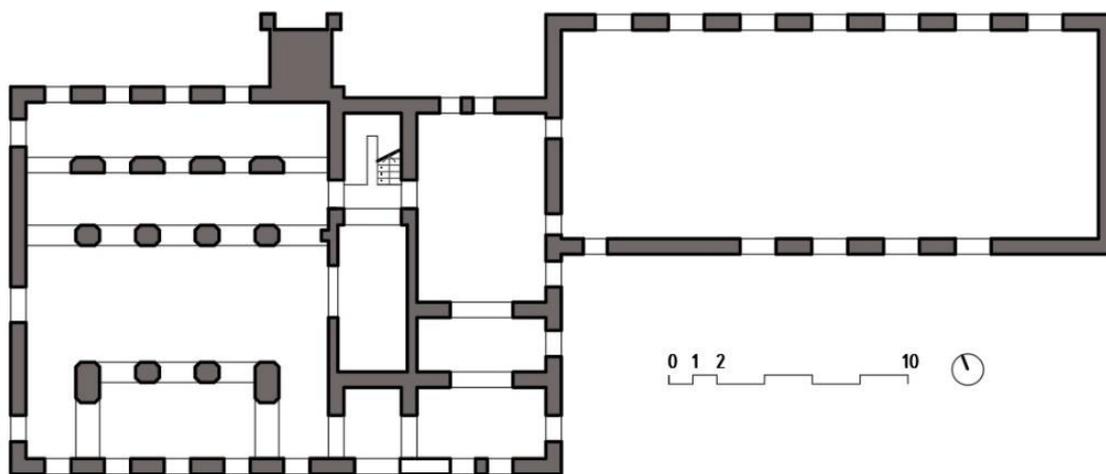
Sanatorio de Cesuras, planta sótano. Elaboración propia
